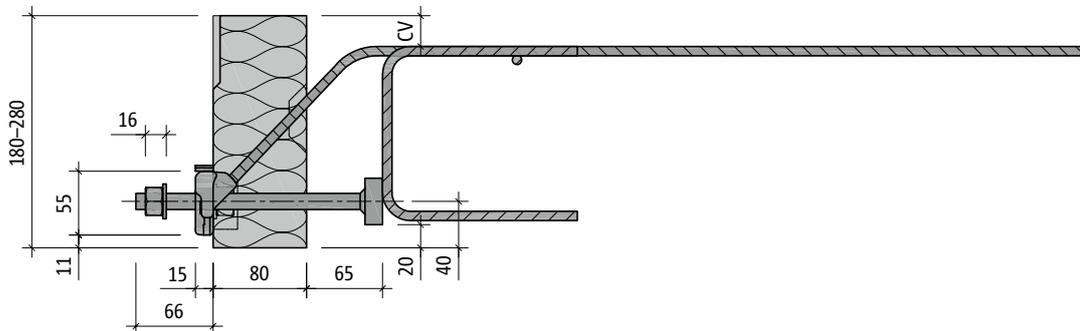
Schöck Isokorb® T tipo SQ-V1: Sección del producto
